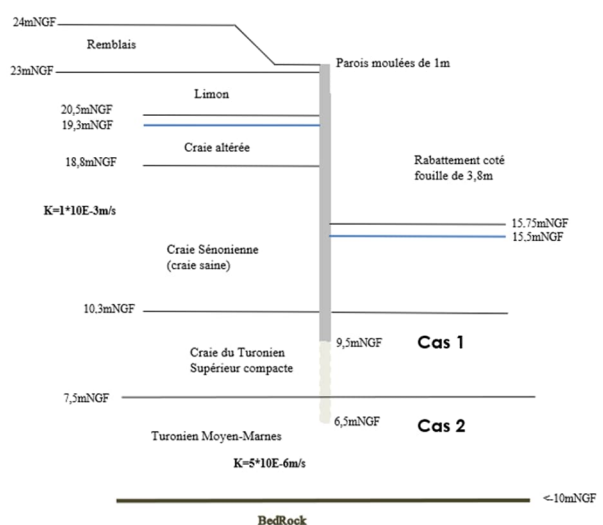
Coupe type au niveau de l'ouvrage de franchissement
